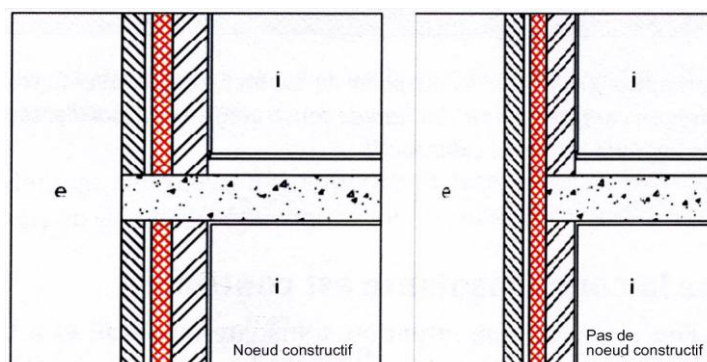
Un appui de plancher sur une façade est seulement un nœud constructif si la couche isolante de la façade est interrompue (à gauche).
